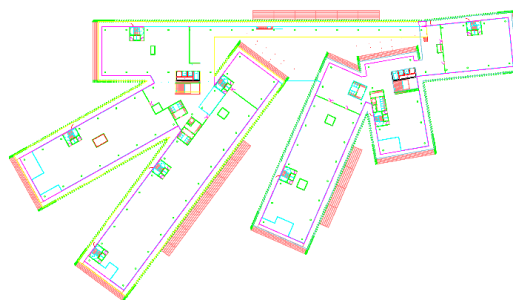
Planta tipo sobre rasante (fase 1). Los seis edificios se unen en el vestíbulo, lado norte
